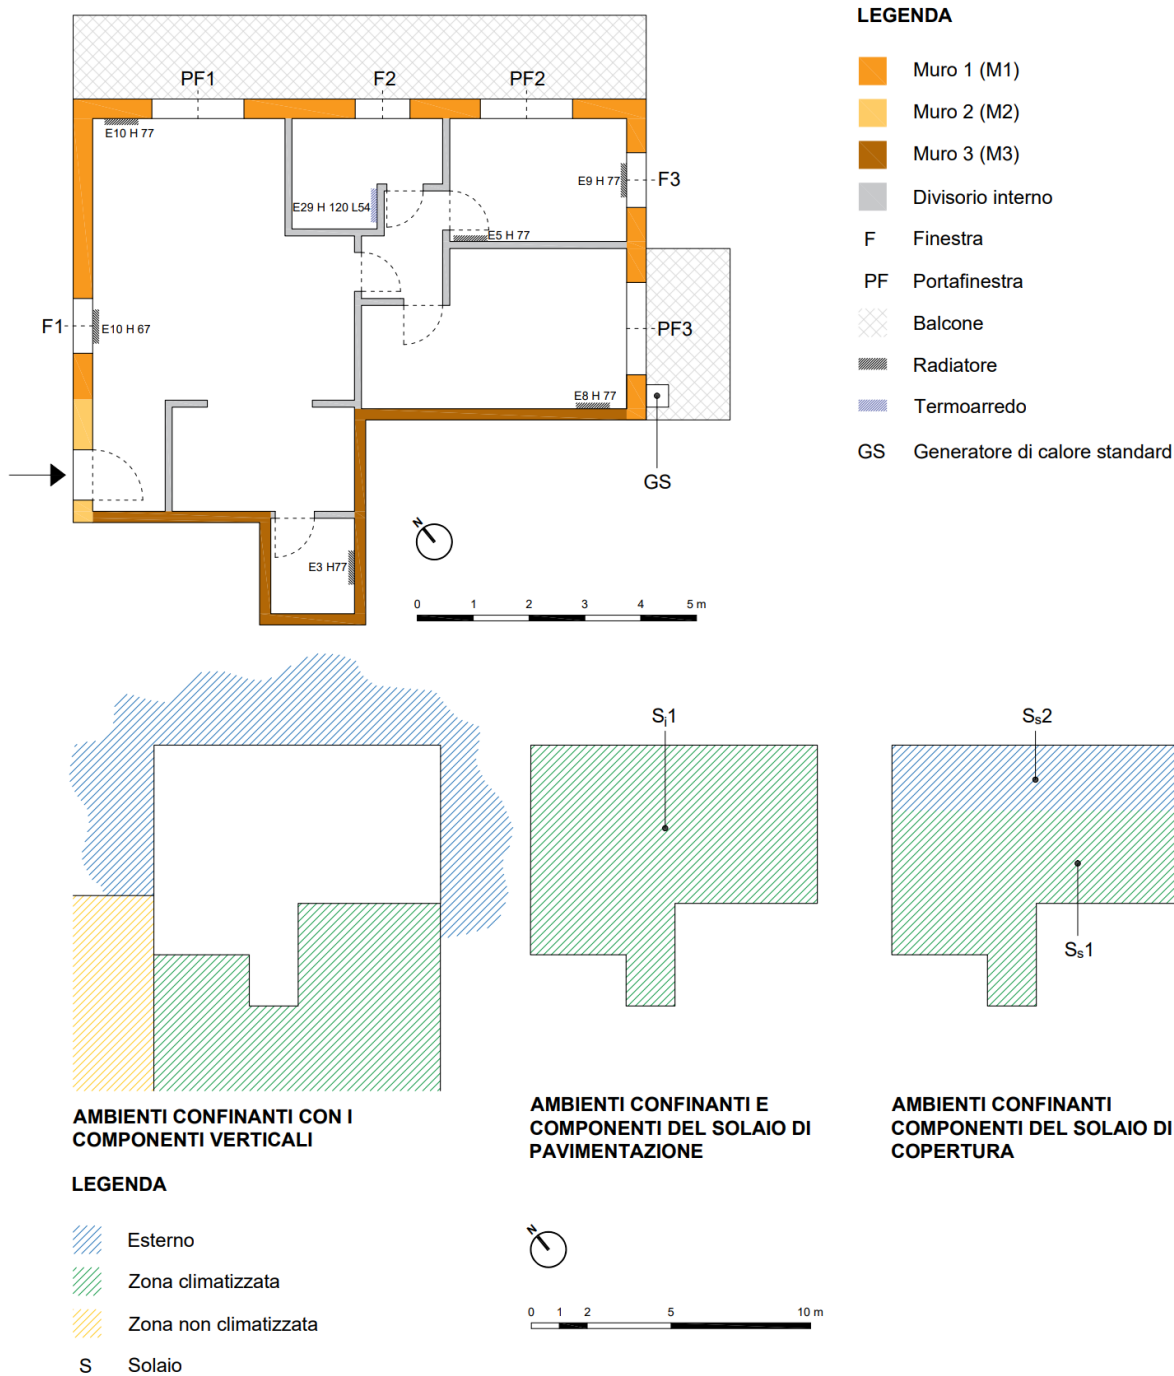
Caratterizzazione geometrica e individuazione delle zone confinanti.
